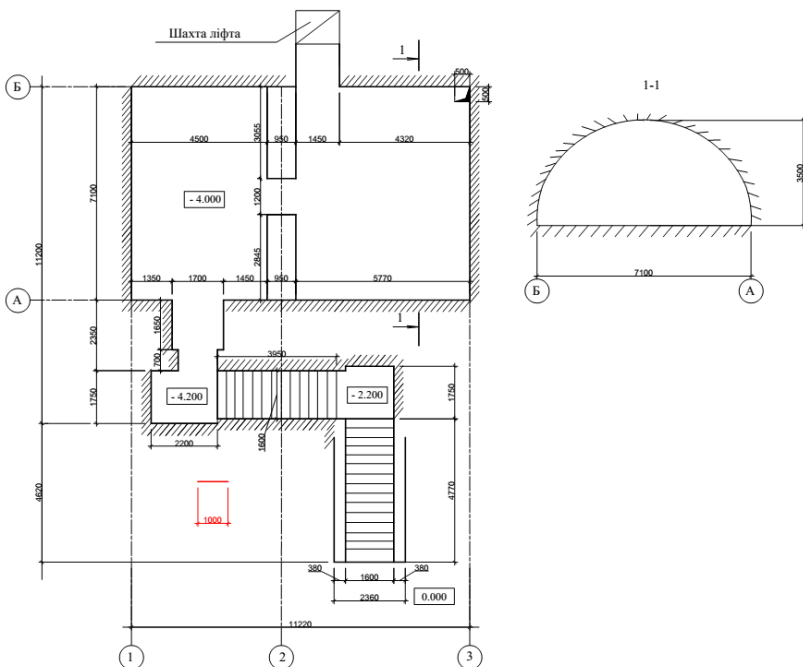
План подвальной части Дома Игумена, которая была доступна к осмотру и разрез 1-1 плана подвальной части (черт. авт.)
